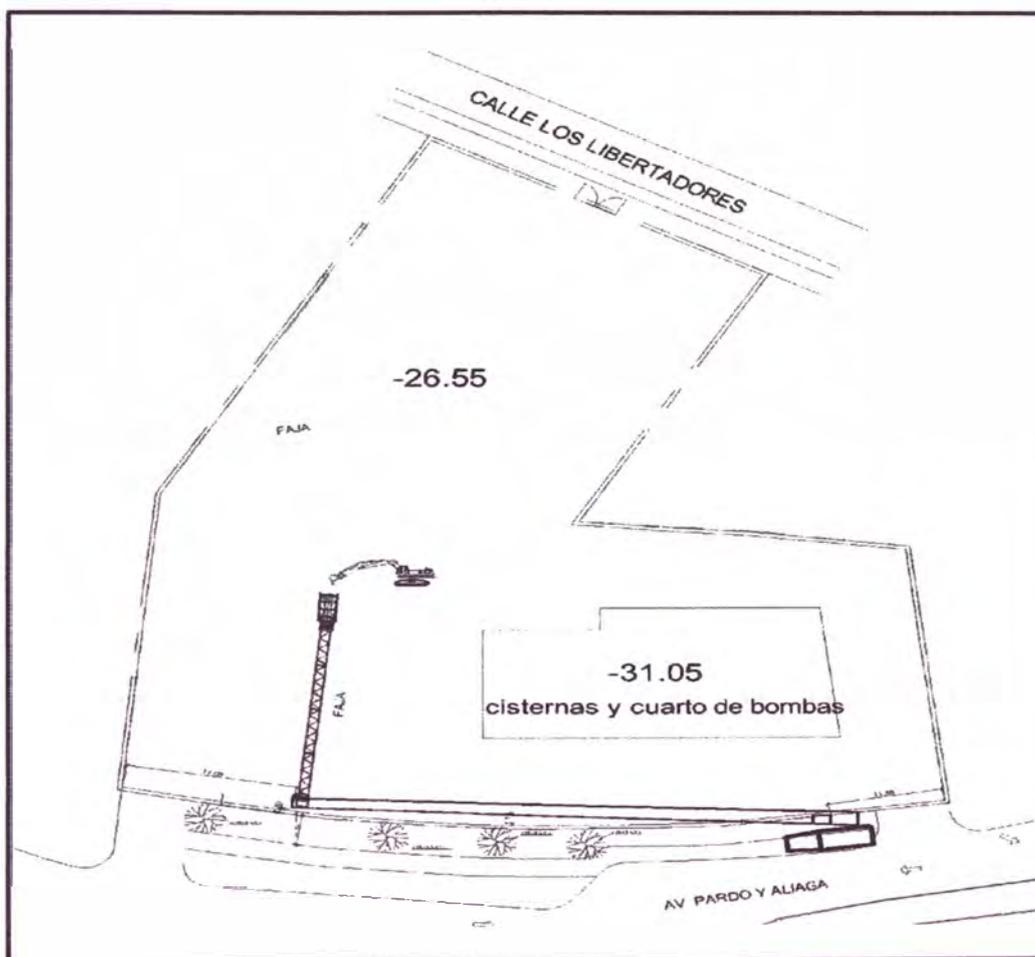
Vista en planta del corte de cisternas y el cuarto de bombas, obra "Edificio de Oficinas Pardo y Aliaga".
